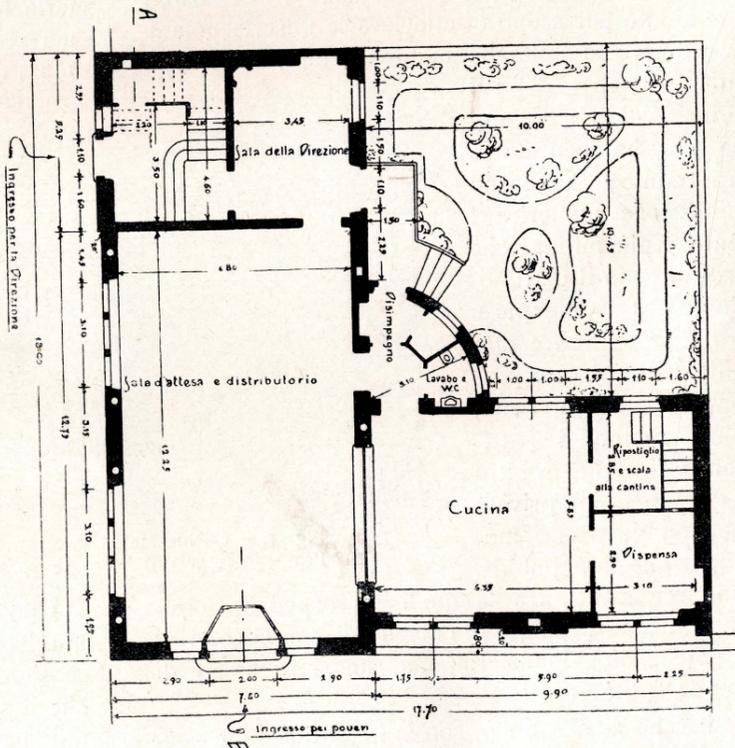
Cucina Malati Poveri - Torino. - Pianta del pianterreno.
